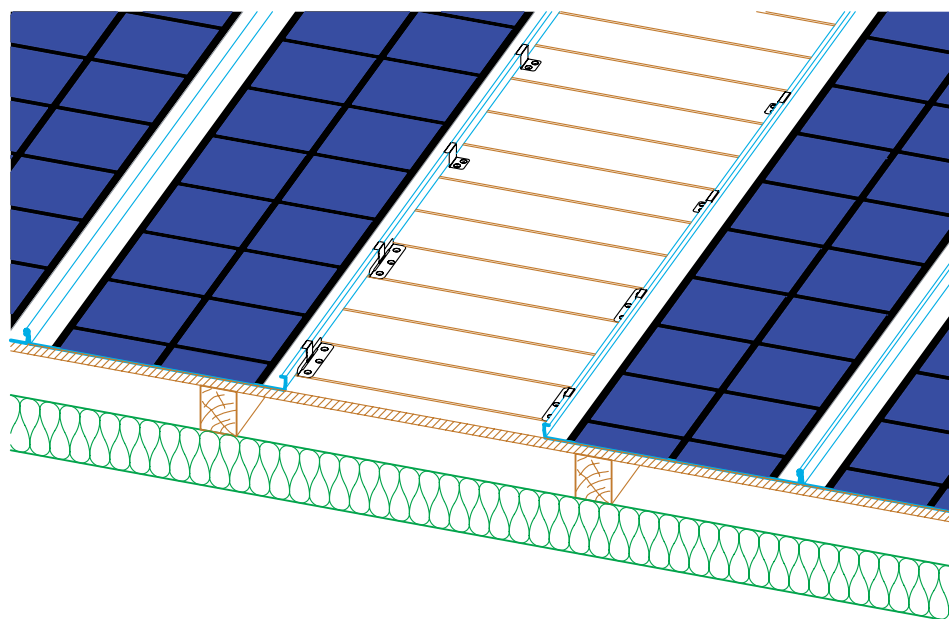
Bac de remplacement joint debout femelle/femelle
